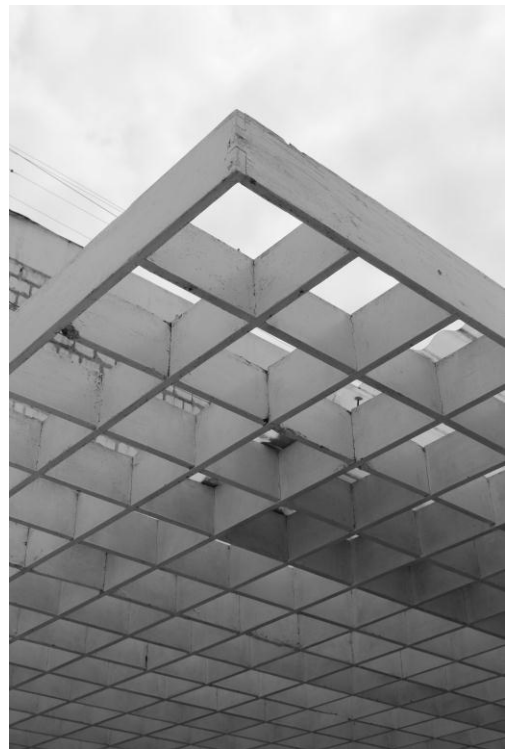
Cubierta - exteriores. Fuente: Propia.
